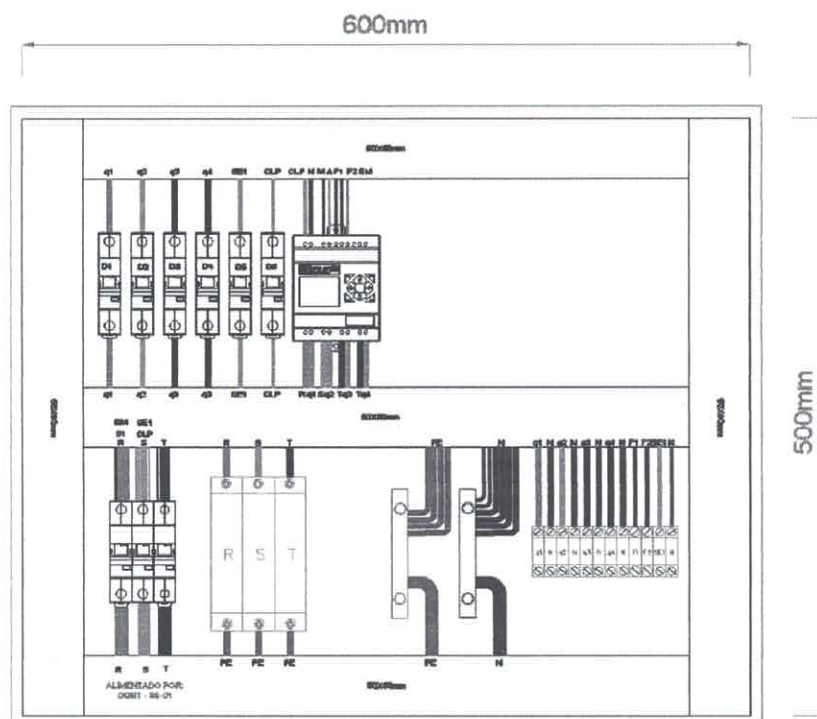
LAYOUT INTERNO – CD – SE-02
